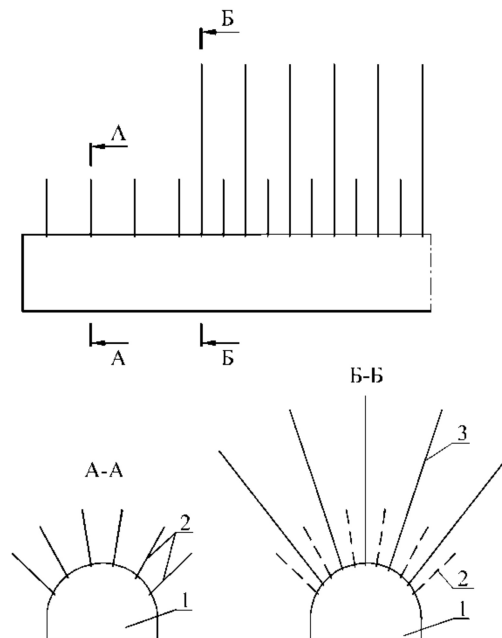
Схема комбинированного способа крепления выработки анкерной крепью: 1 – забой выработки; 2 – жесткая анкерная крепь; 3 – податливая анкерная крепь
